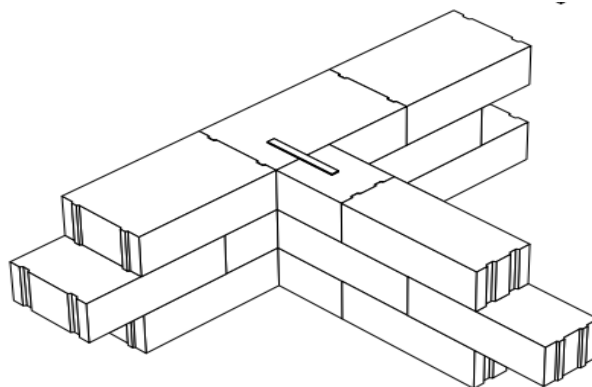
Фрагмент кладки та фіксації внутрішньої перегородки до зовнішньої стіни з газобетонних блоків.
